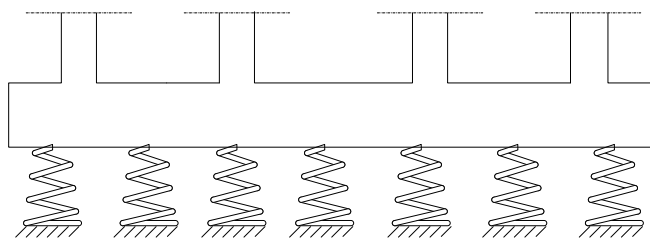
Esquema de aplicação do modelo de Winkler: viga apoiada em meio elástico.
